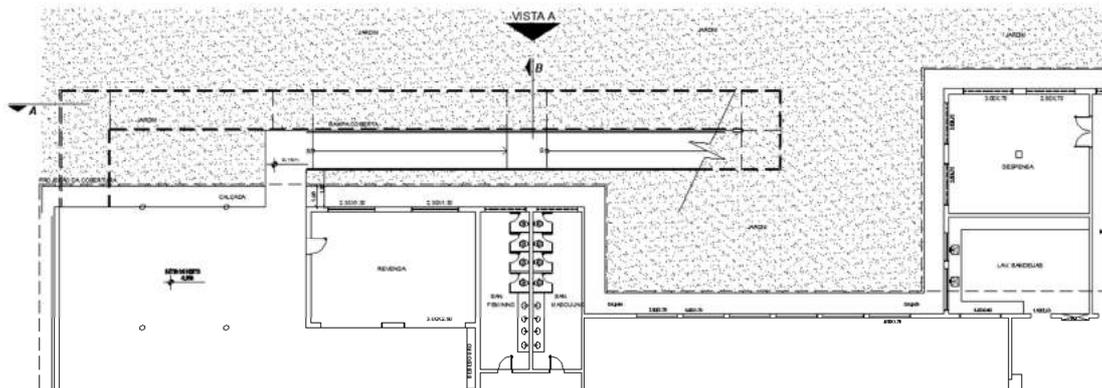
PAVIMENTO INFERIOR - BLOCO ADMINISTRATIVO – CAMPUS PLANALTINA
